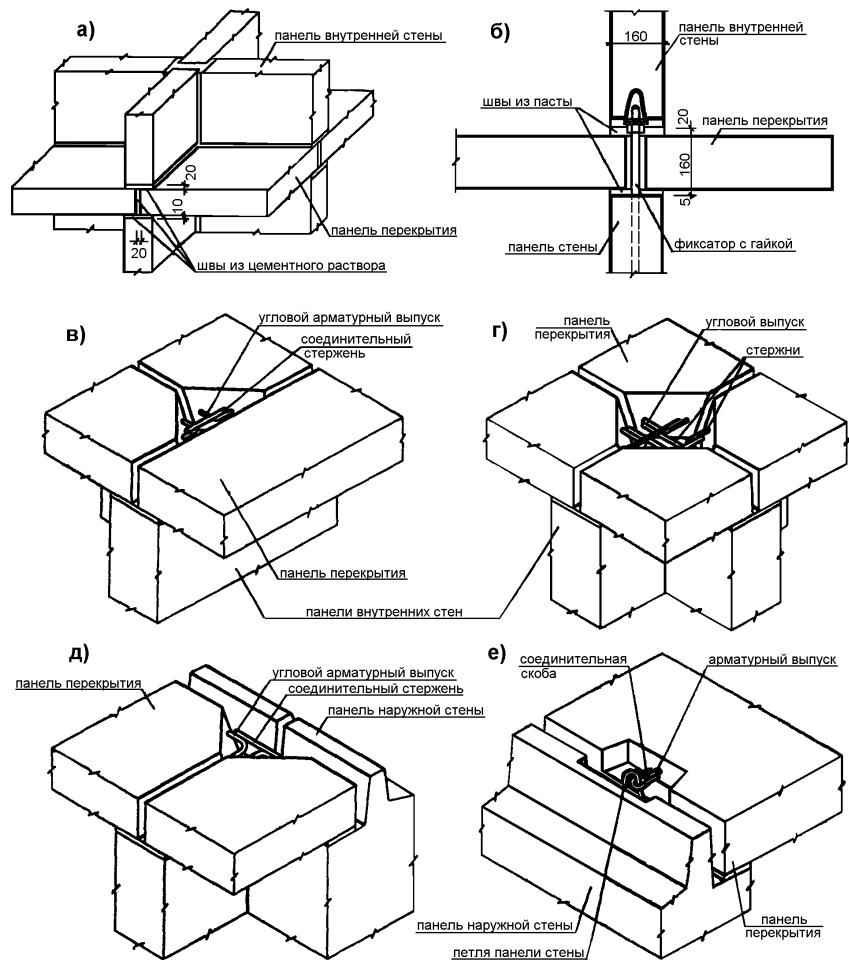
Детали опирания панелей перекрытия крупнопанельных зданий.
